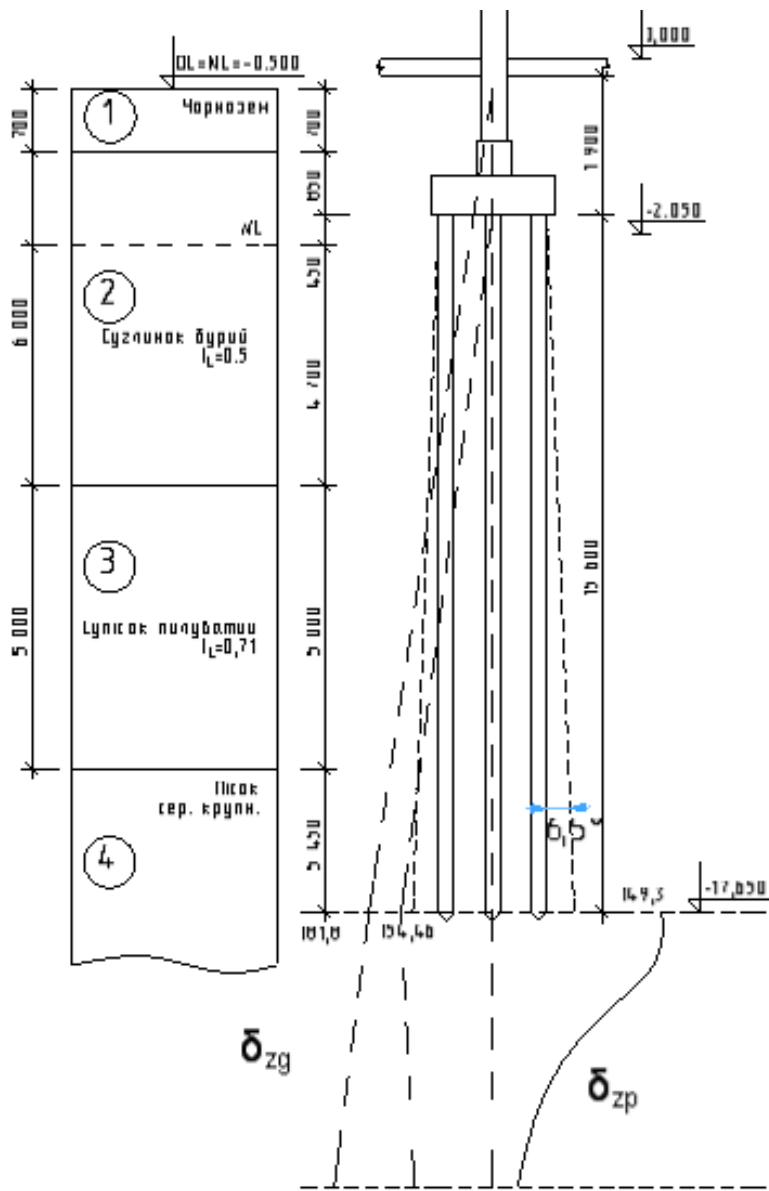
Схема розрахунку осідання пальового фундаменту
